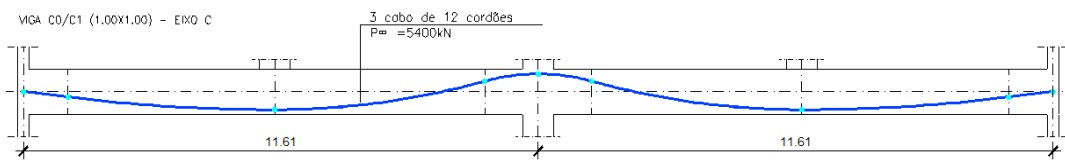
Alçado da viga pré-esforçada de transição – Alinh. C, pisos 0 e 1
